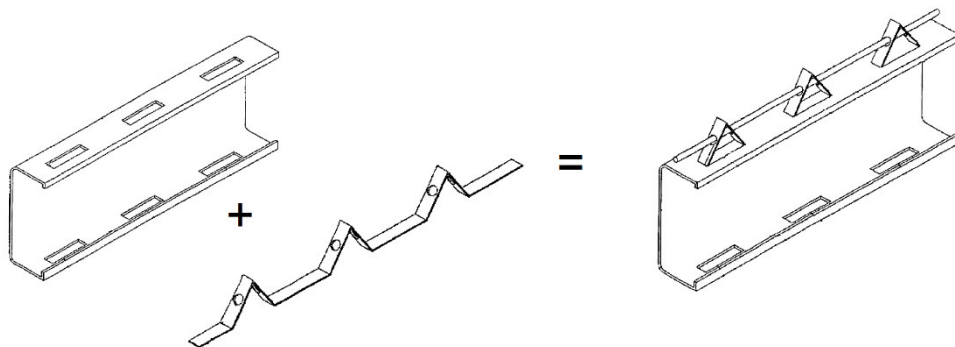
Elemento estrutural com conexão por encaixe. (adaptado de RUIZ, 2009)
